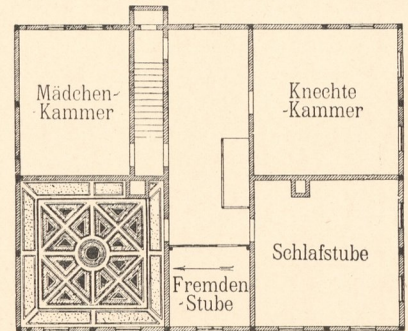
Bauernhof in Hochbuch. Grundriss vom Obergeschoss des Wohnhauses.
